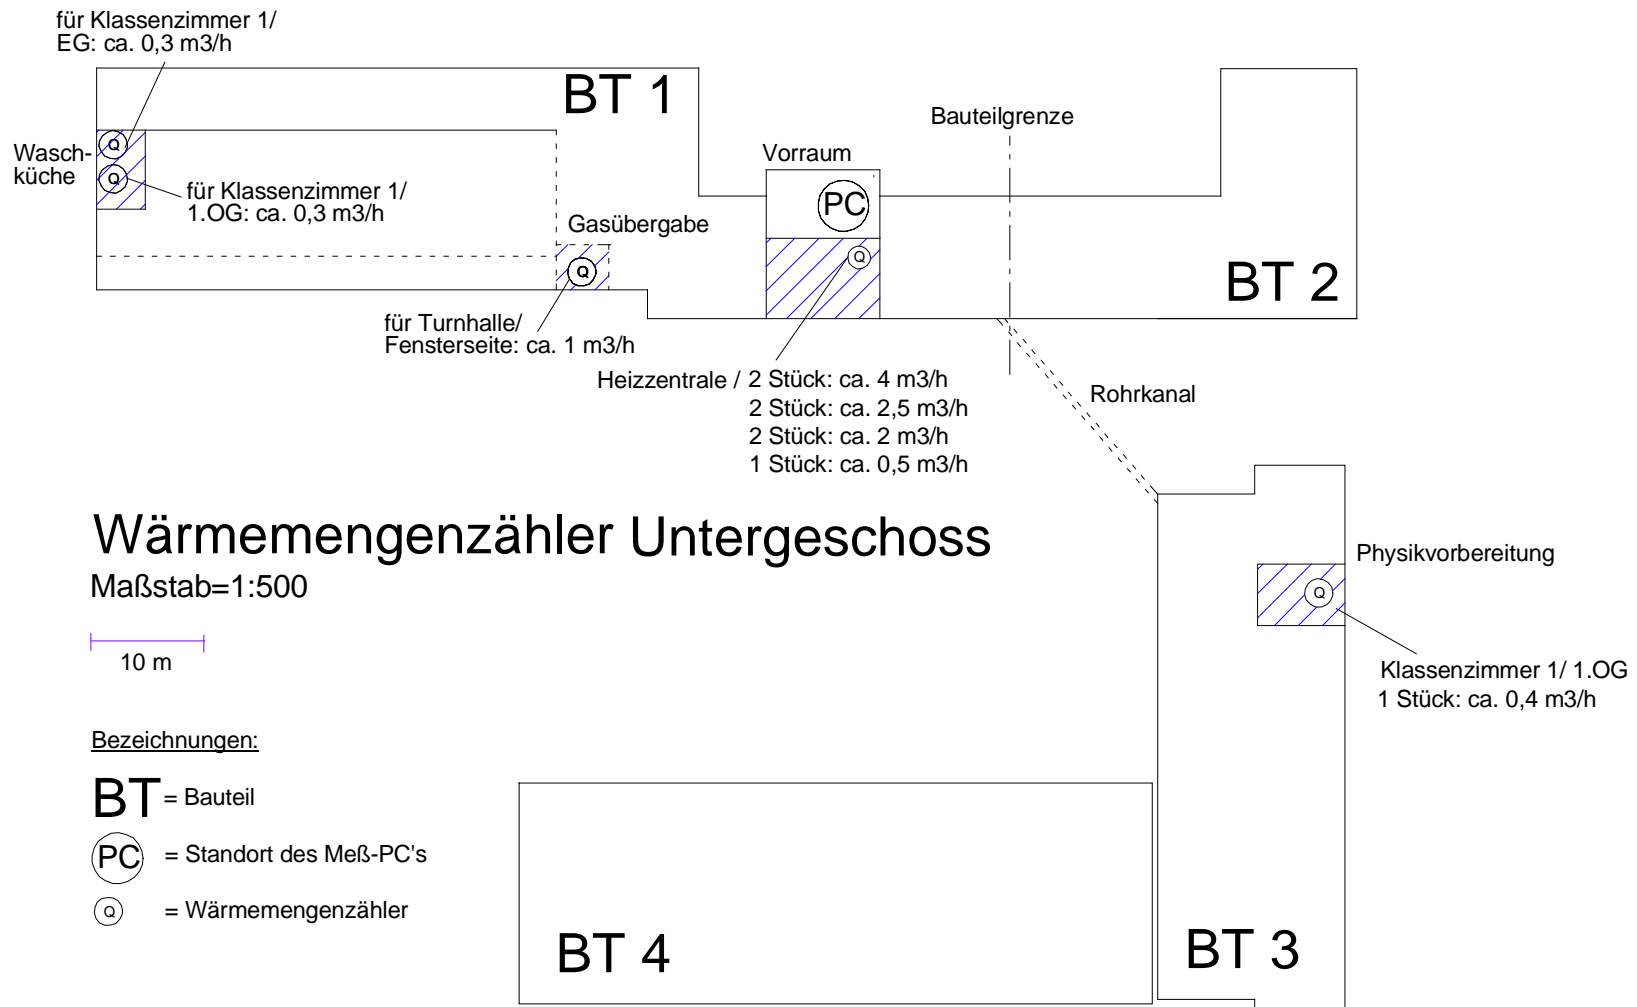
Einbauort der Wärmehzähler im Untergeschoss
